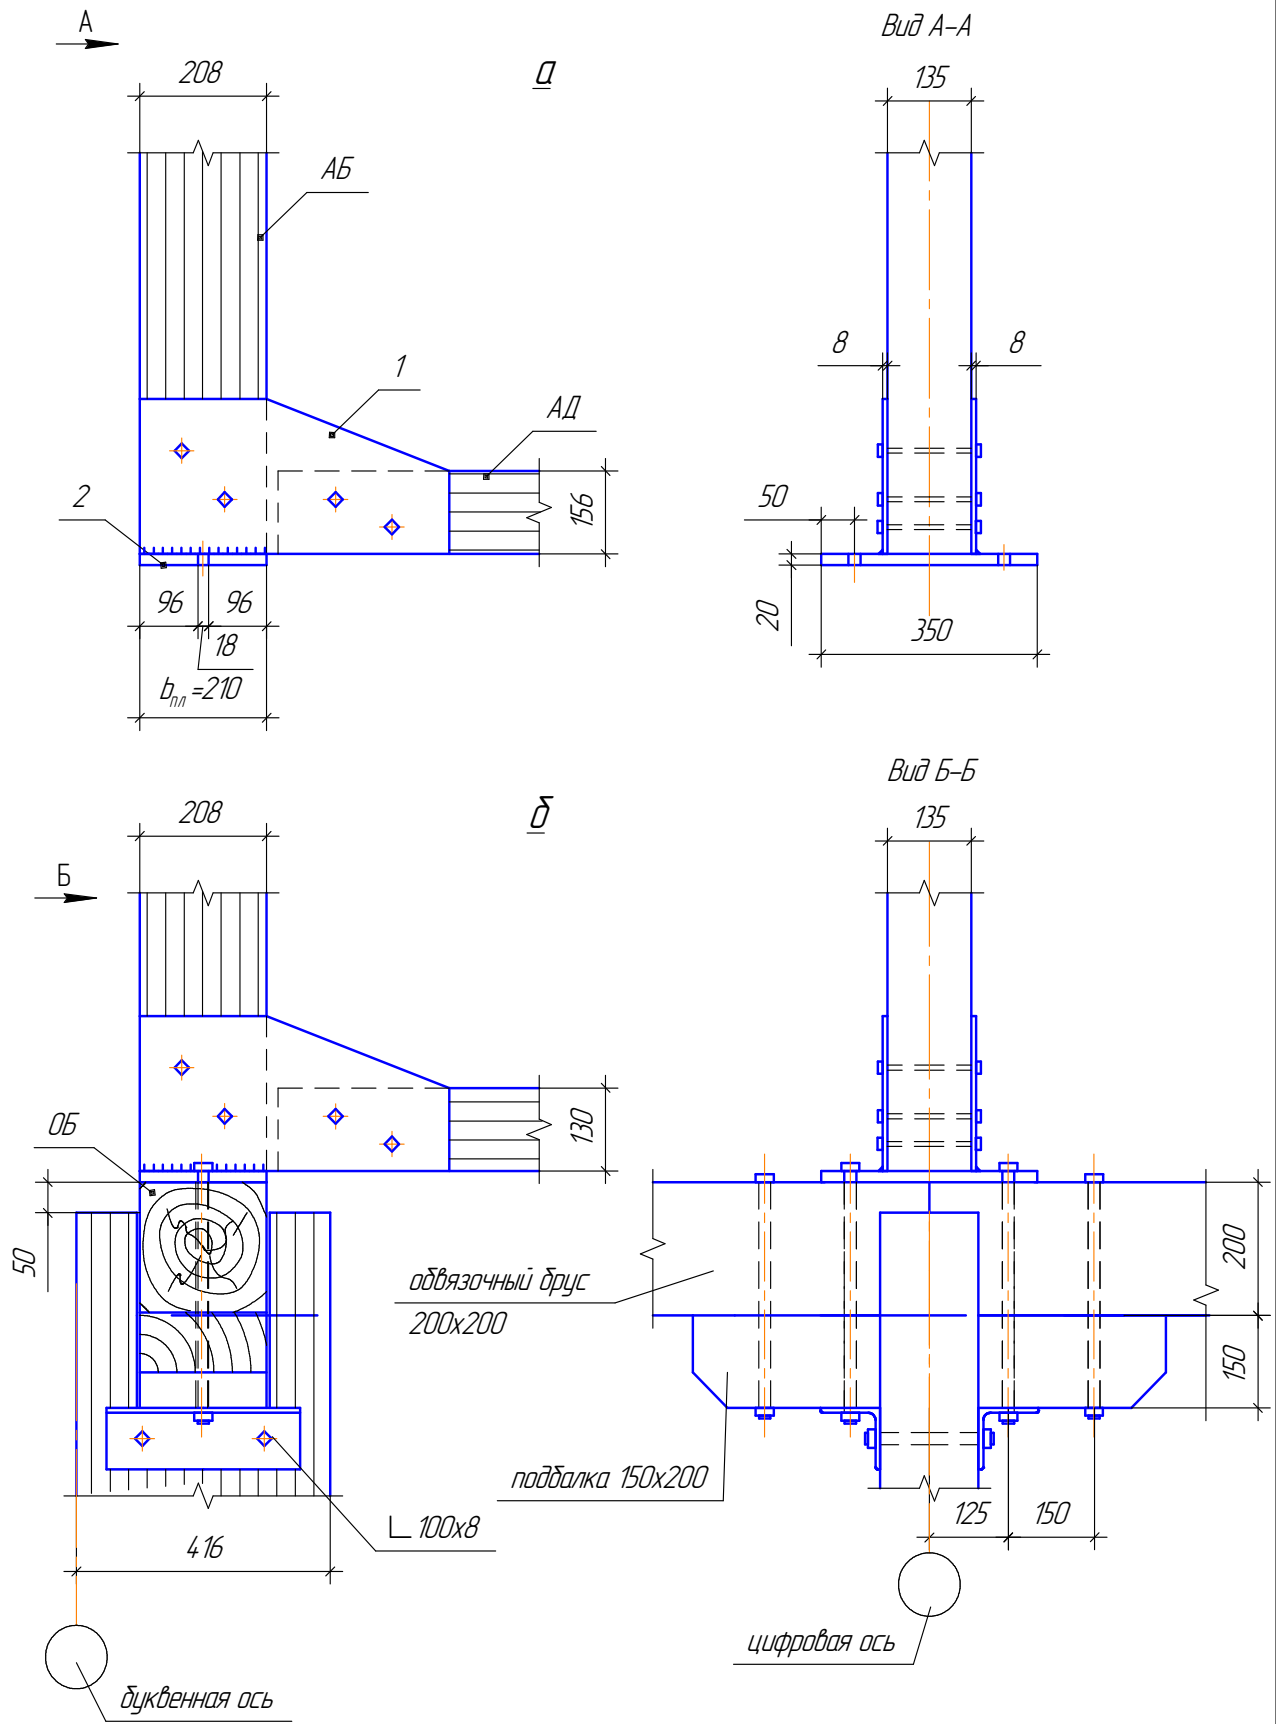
Опорный узел А (а) и узел крепления фермы к стойке (б)
